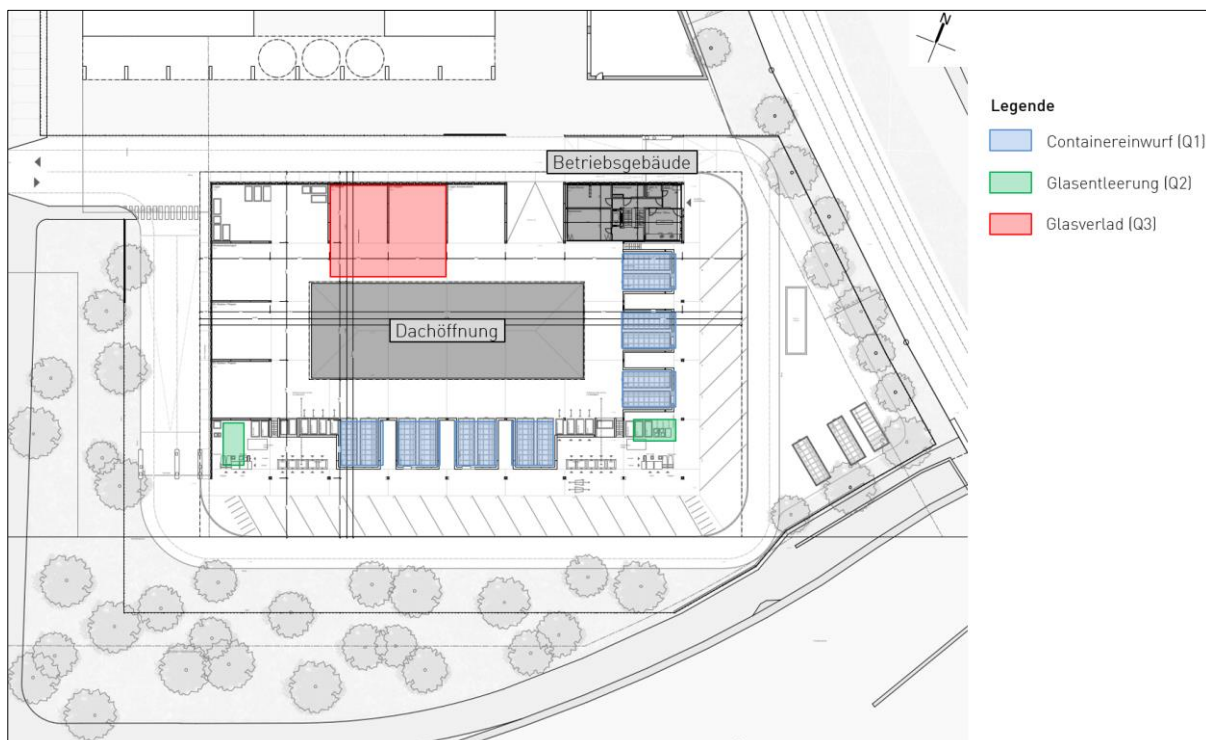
Ausschnitt des geplanten Grundrissplans mit den verschiedenen Lärmquellen
